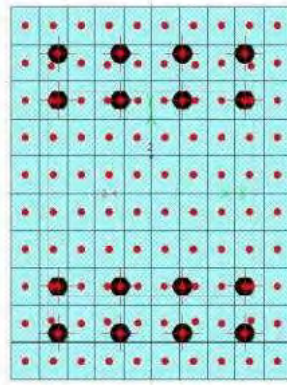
Fibras longitudinales de acero y concreto para la columna de concreto armado
